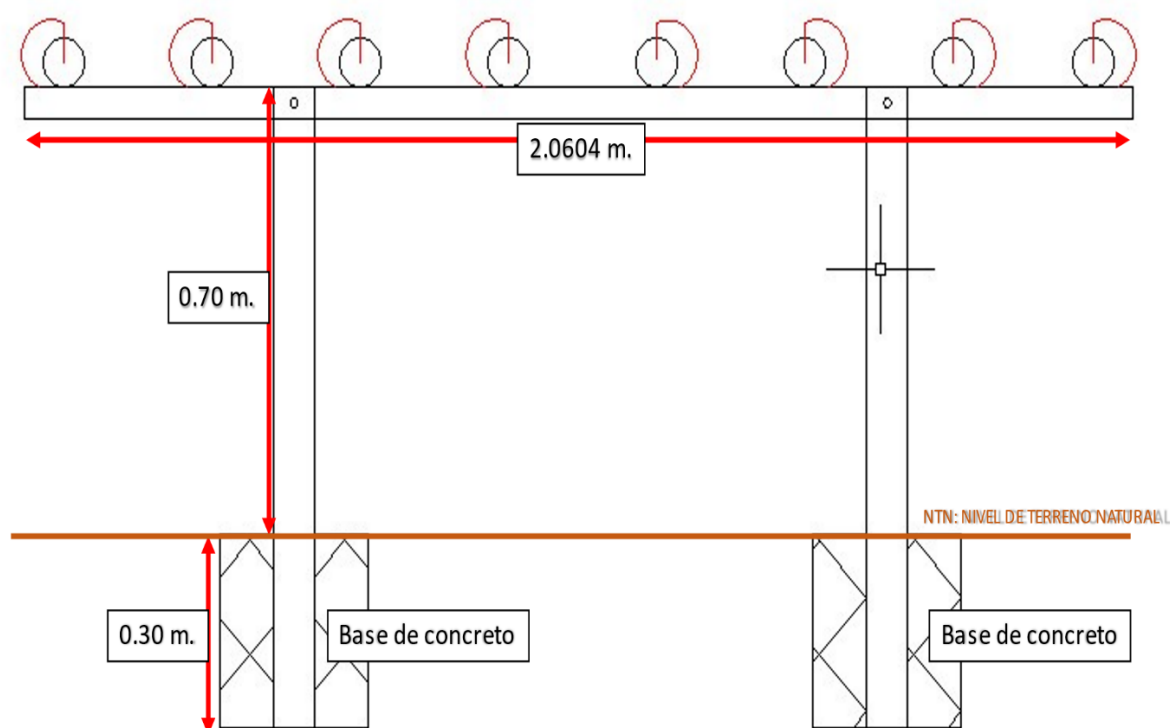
Corte estructural de un soporte para una carga de 8 tubos de cultivo.
